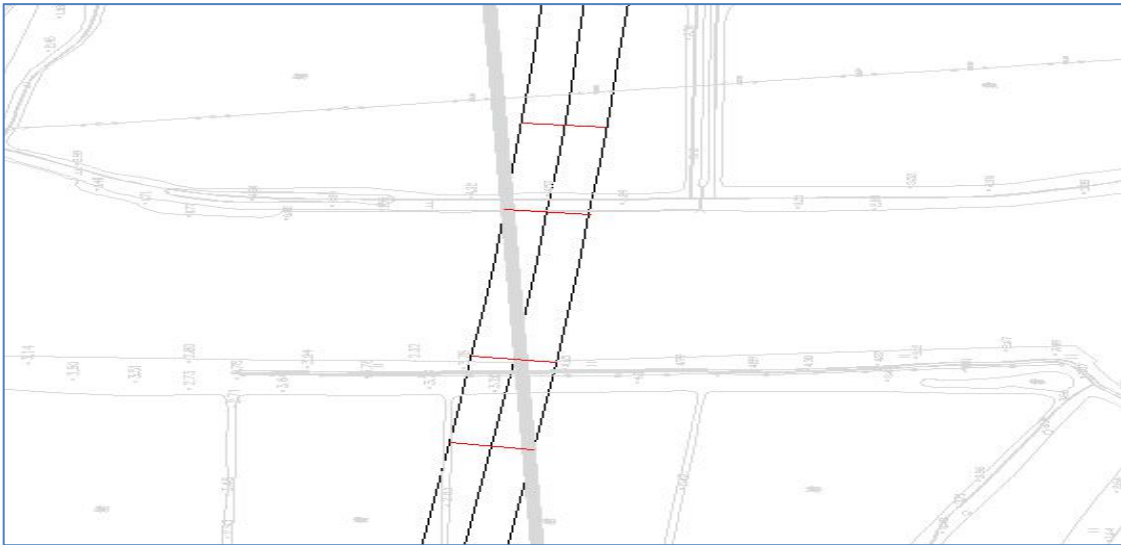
主桥桥位平面图（尺寸单位：m）
